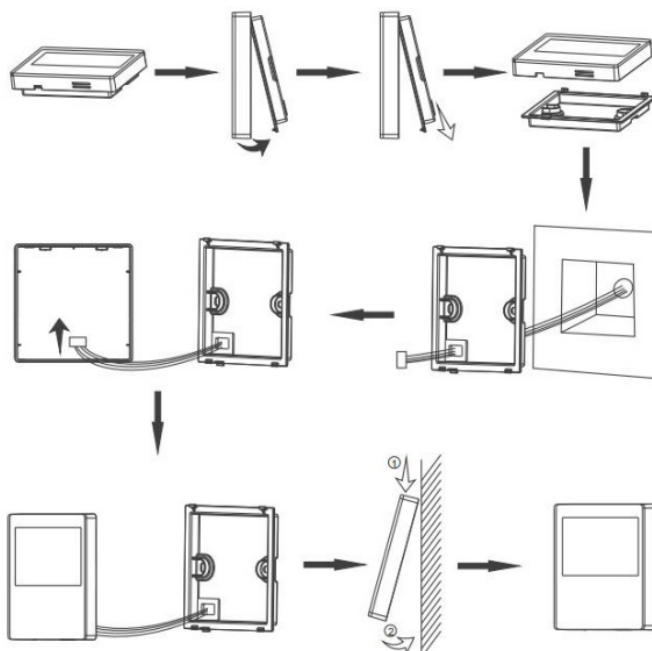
Boîtier d'installation pour contrôleur filaire
